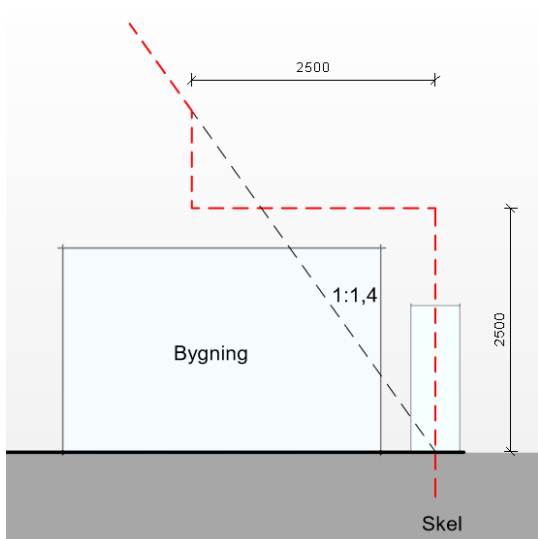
Planskitse med eksempel på placering af småbebyggelse
